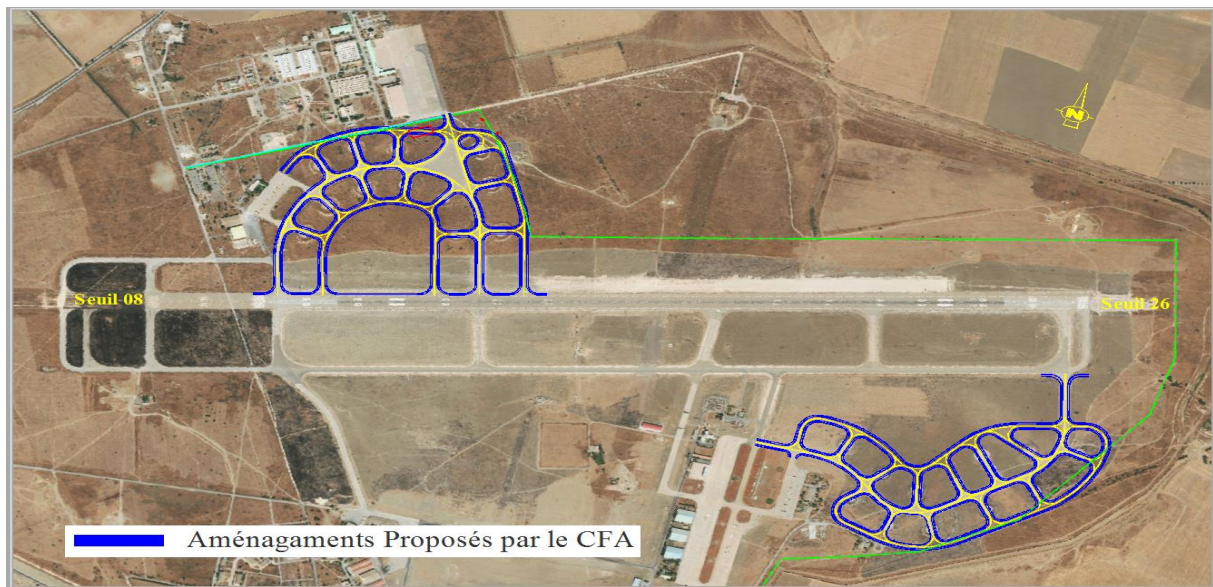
Plan Général : Situation des Voies de Circulations Projetées au Seuil 08 et 26 [CFA].
